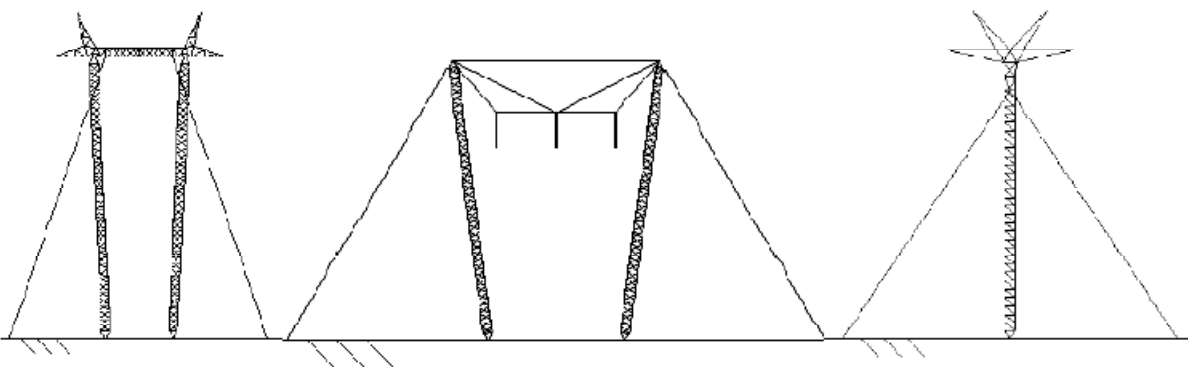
Estruturas de torres estaiadas (DANZIGER, 2010)
